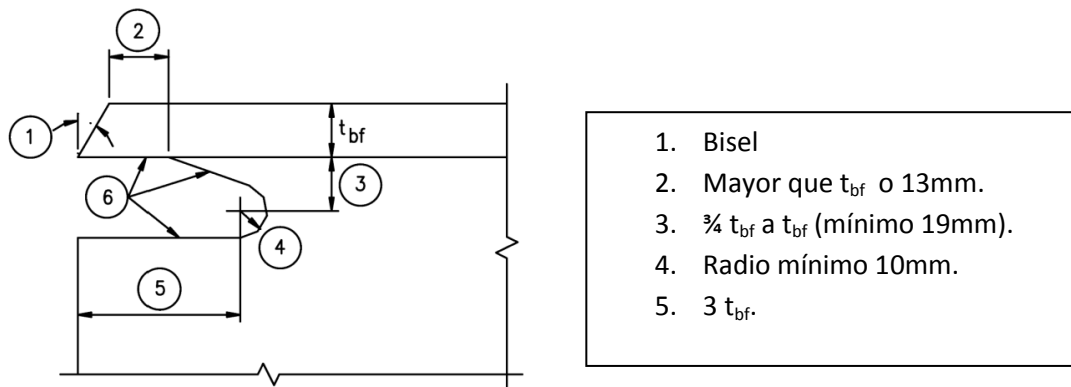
1 detalle de agujero para acceso de soldadura (FEMA, 2000a)
